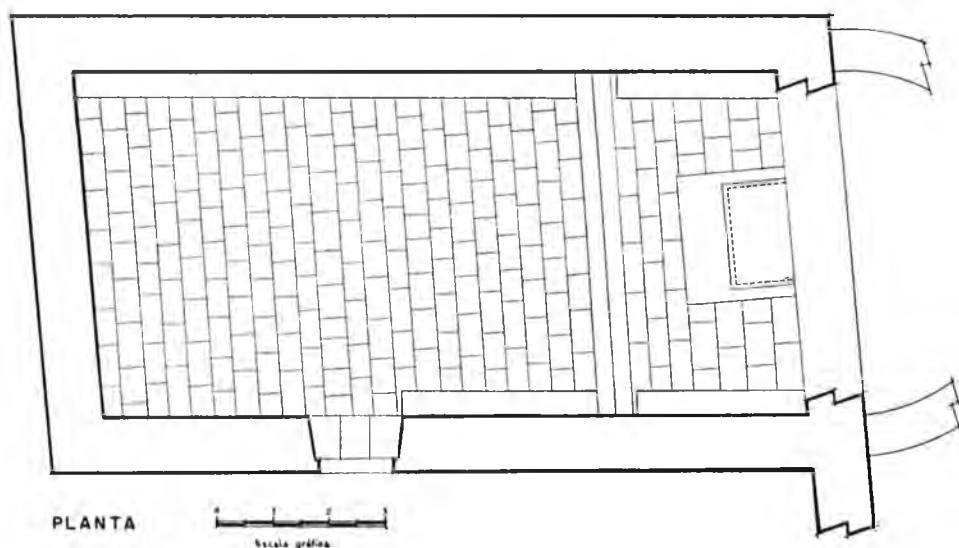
Planta de la ermita de S. Miguel, en Villatuerta.
